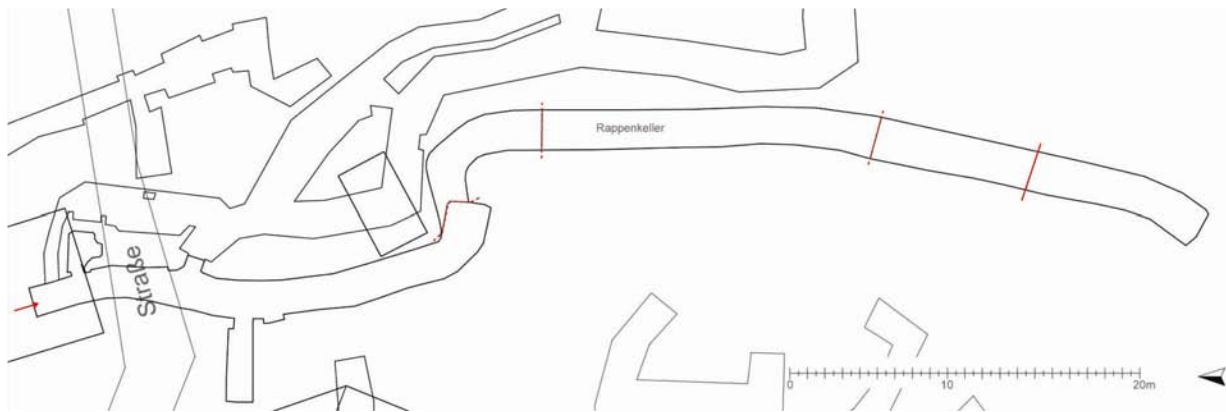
Grundriss Rappenkeller mit Kartierung der Bauphasen (rot)
